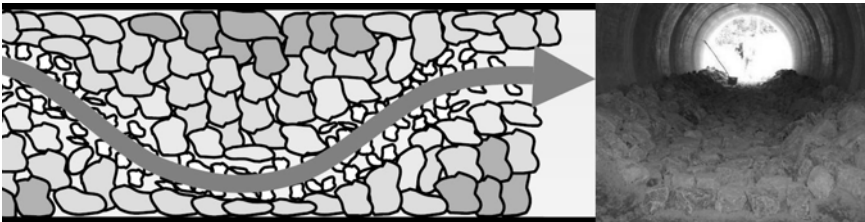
Rohr- bzw. Stollendurchlass in geschlossener Bauweise [6]
